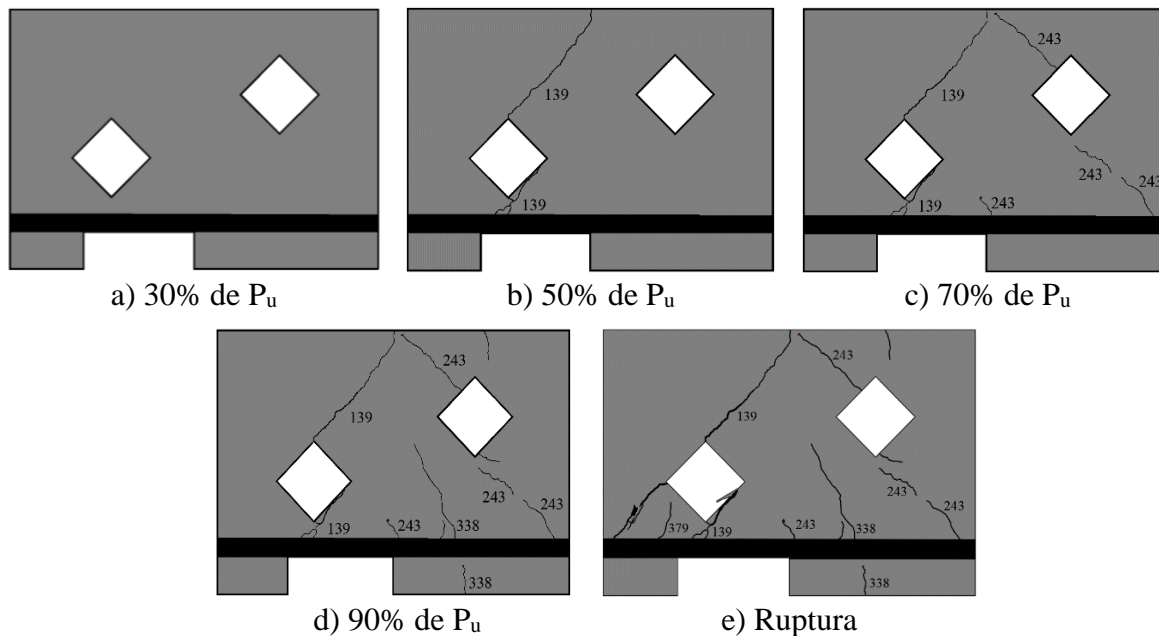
Mapa de fissuração DB3-W-H2-S-F-1 (força indicada em kN)
